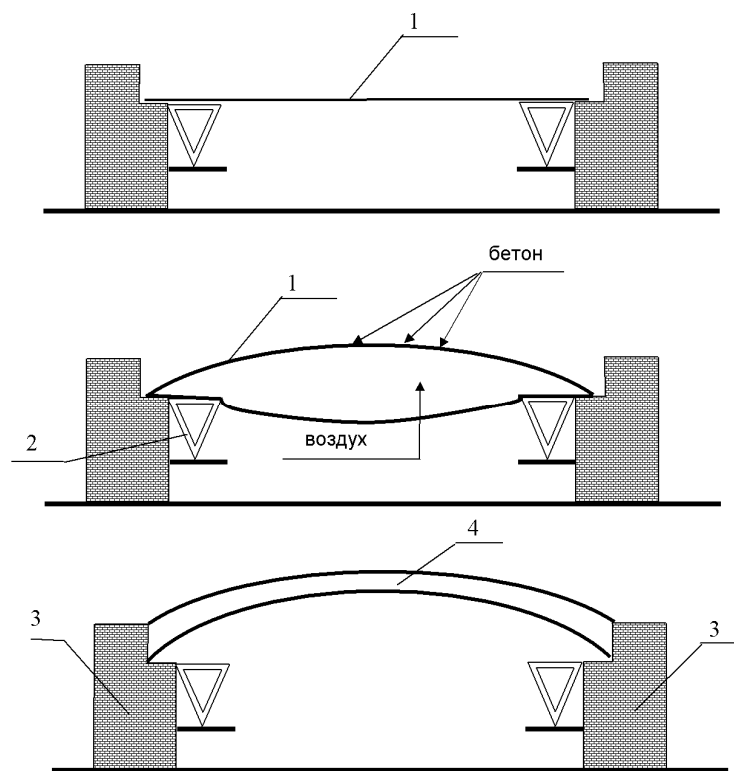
Бетонирование вспарушенных плит с использованием пневмоопалубки А.Э. Лопатто: 1- пневмолинза, 2- опорный контур, 3 – несущие стены, 4 – монолитная оболочка
